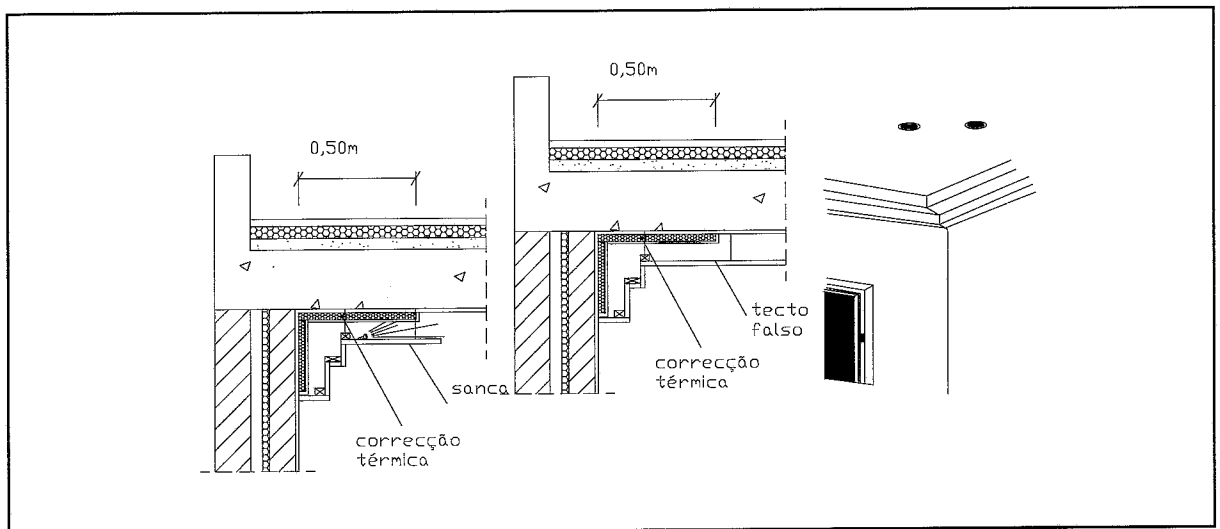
Pormenor de correcção térmica, pelo interior, na zona de ligação parede exterior e laje, com isolante térmico pontual e disfarce com sanca
